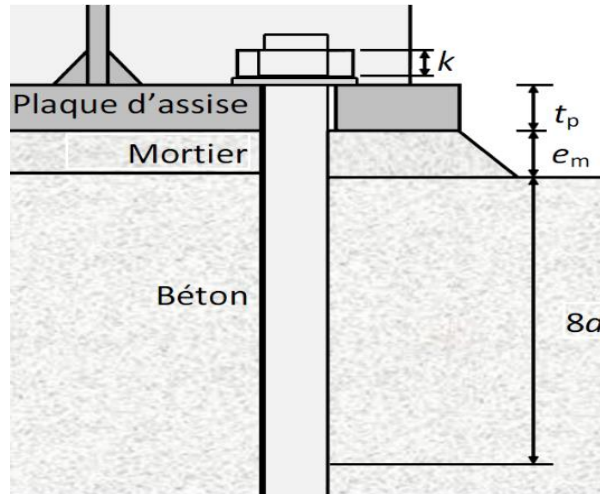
Longeur d'allongement du boulon d'ancrage
